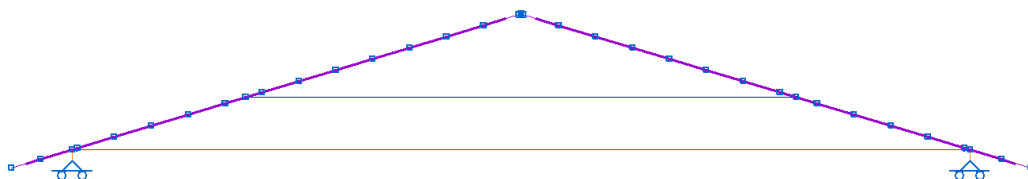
Apoio adotado para as tesouras 2, 4, 6 e 8 (apoio móvel).
